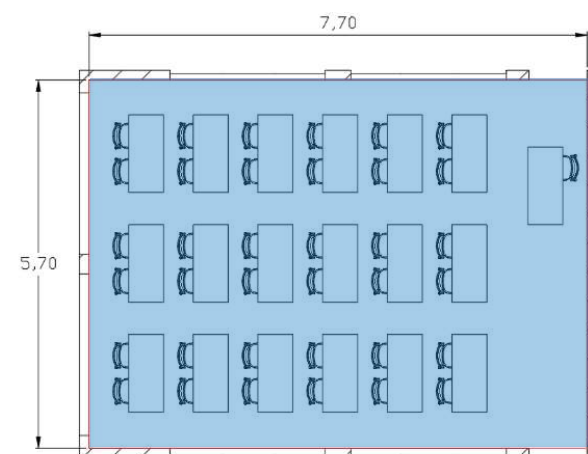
Edificio B, planta de aula tipo PB-N1. Fuente: Elaboración propia.
